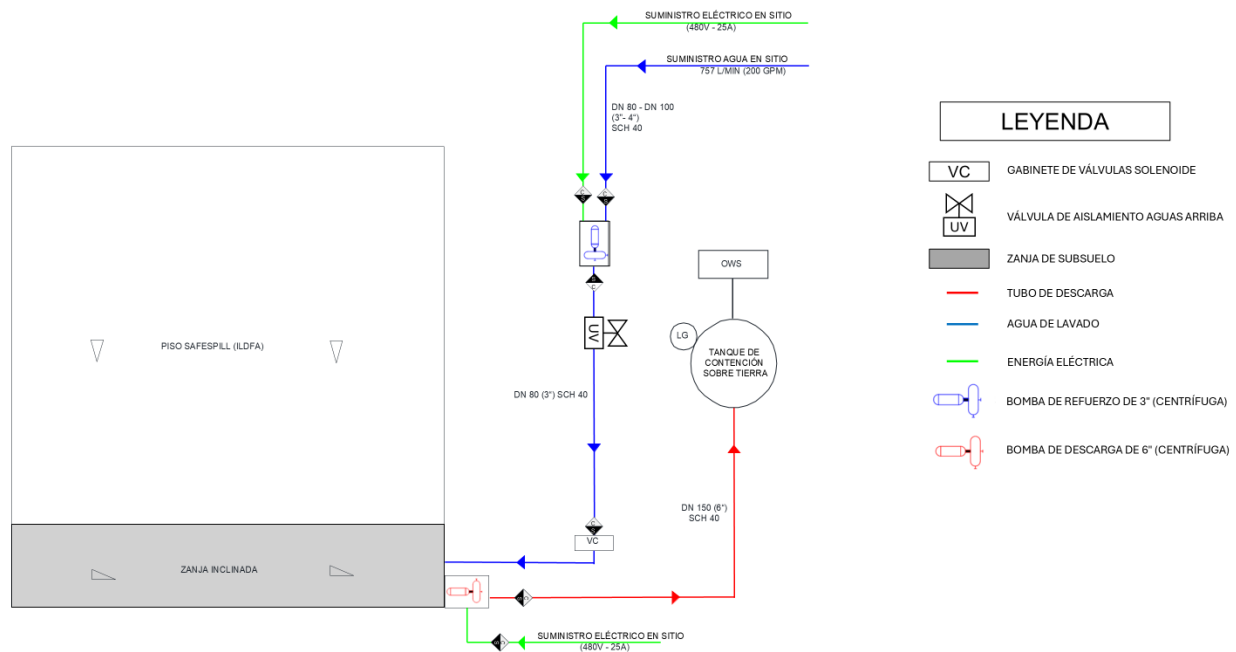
P&ID simplificado de ILDFA con la adición de válvula de aislamiento aguas arriba para la protección contra la congelación
